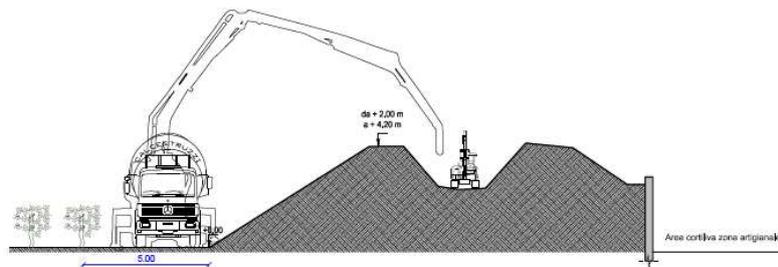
Schema di cantiere con bobcat interno all'alveo e pompa per getto calcestruzzo esterna
